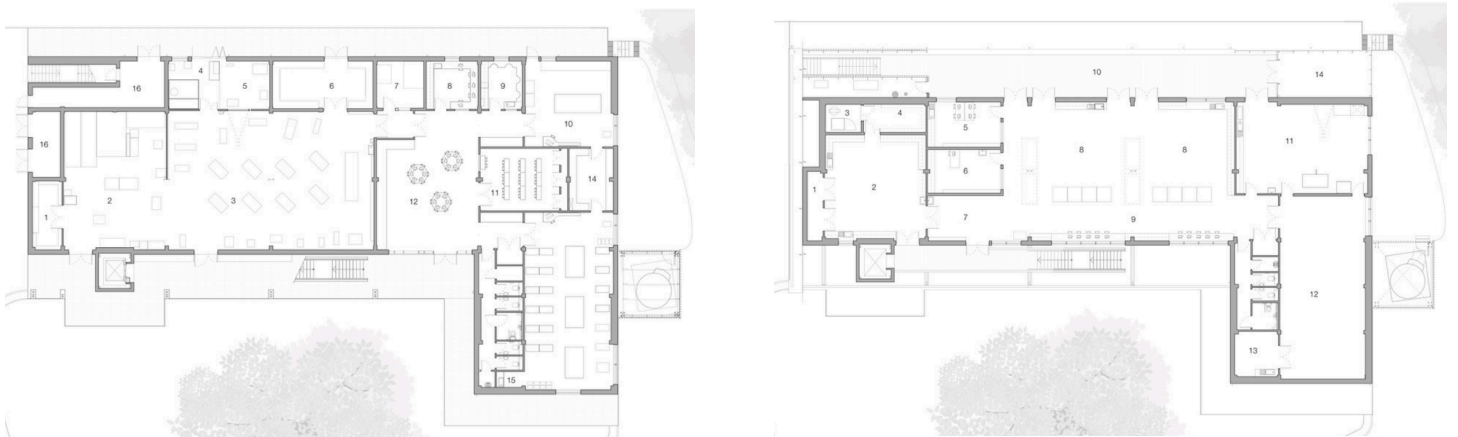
Planta arquitectónica primer y segundo Piso. (ArchDaily, 2016)
